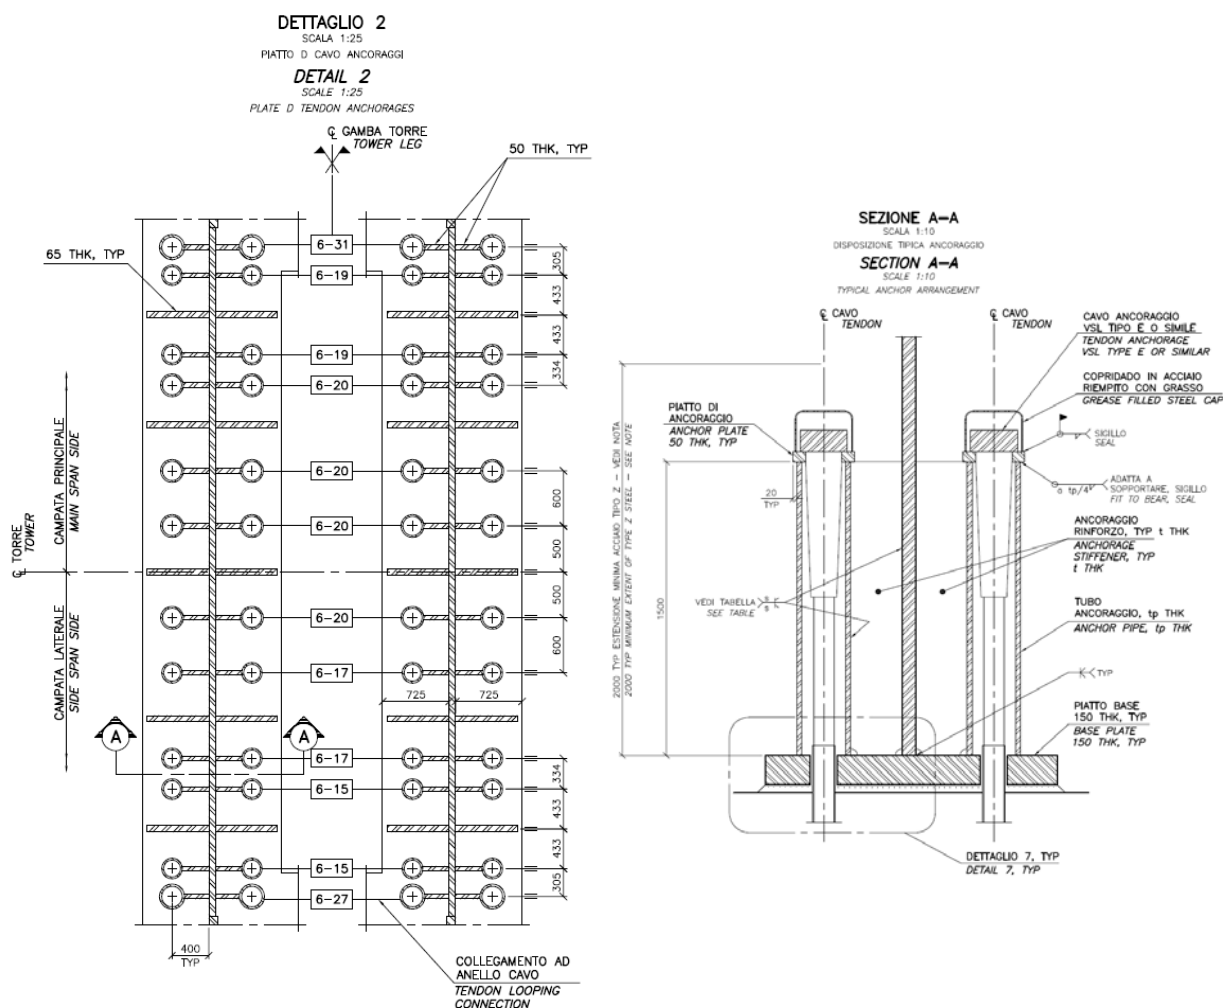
Vista in pianta e sezione trasversale degli ancoraggi del tirante della piastra D.
